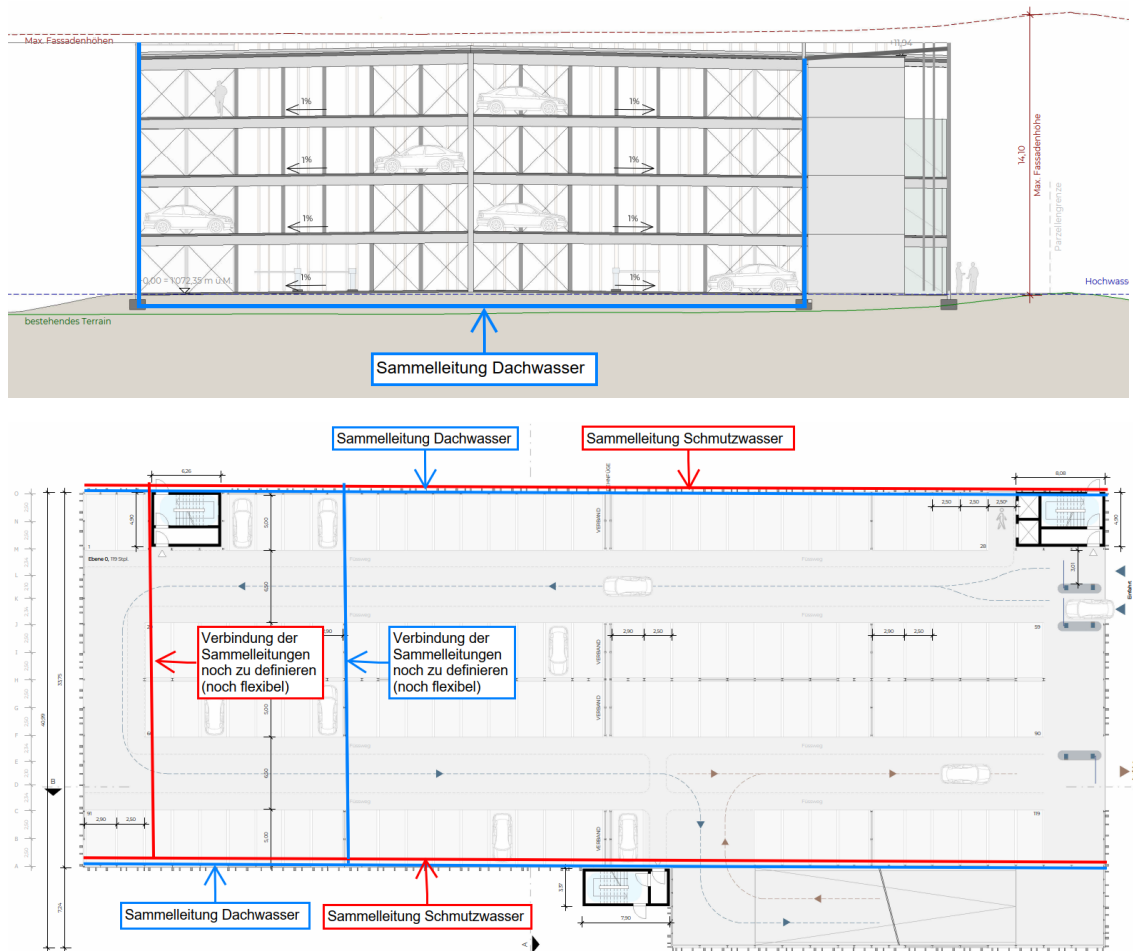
Ansicht der Dachentwässerungsleitung (oben) sowie Entwässerungssammelleitungen auf dem Grundriss (unten), Quelle Plangrundlage: Goldbeck Rhomberg
